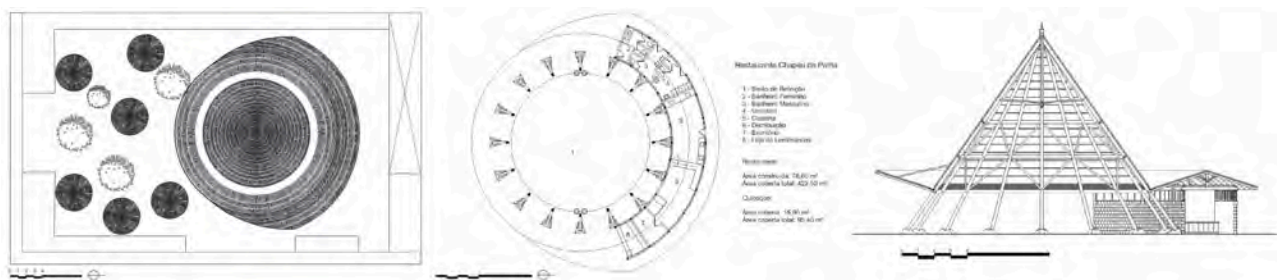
, 36 e 37 - Restaurante Chapéu de Palha | Implantação | Planta | Corte.
